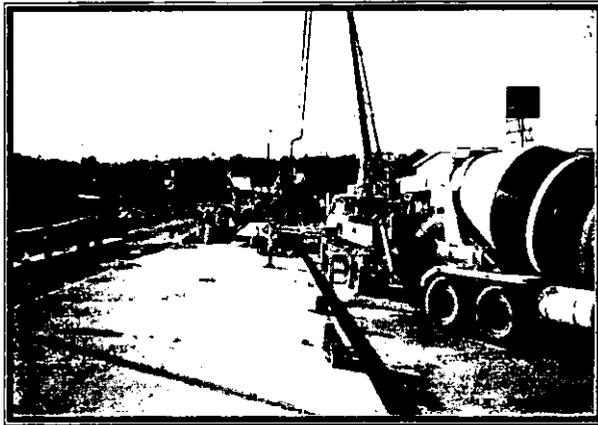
Colado del primer tramo de pila empleando bomba para concreto
